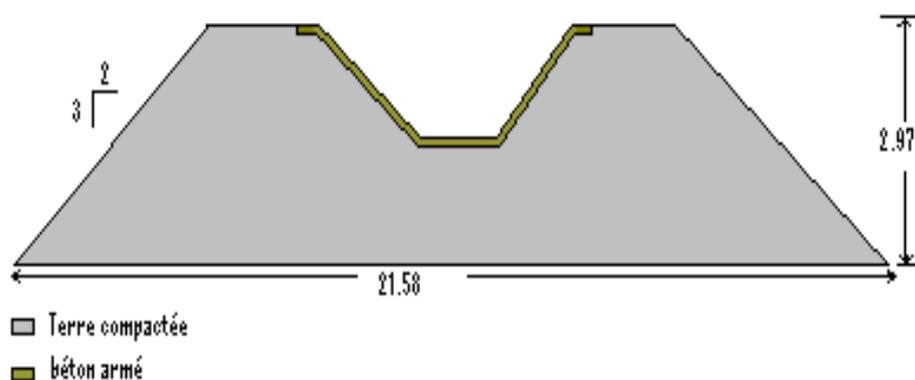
Coupe transversale en début du canal principal (point numéro 1 du tableau 2)
